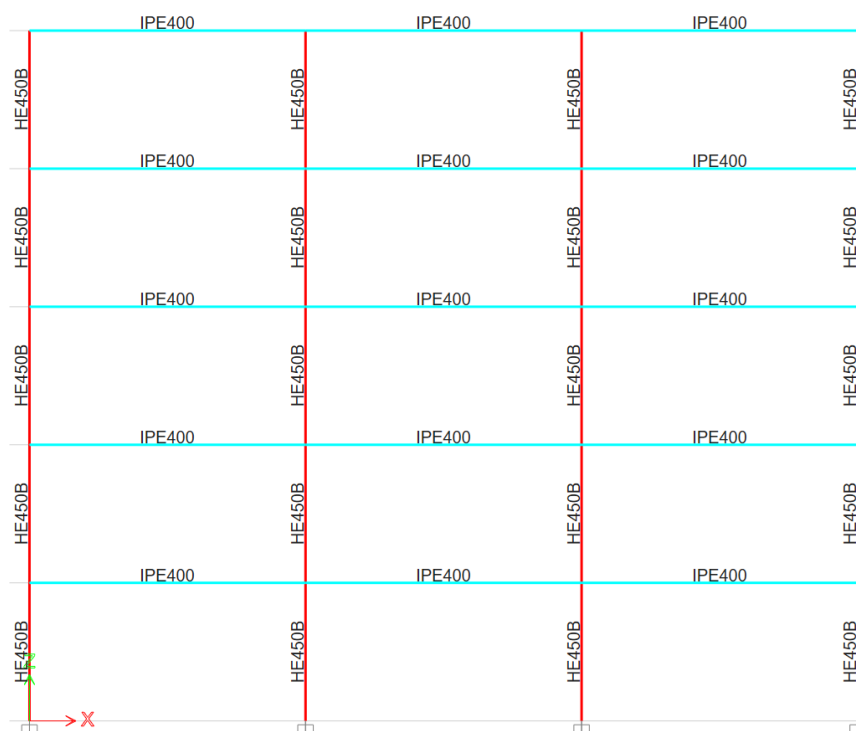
Modelo 1 Columna tipo I – Viga tipo I
